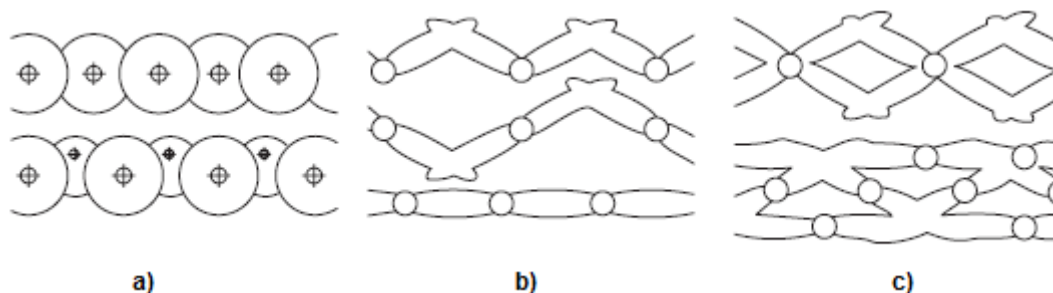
Esquema de estruturas em jet grout: a) cortina de colunas, b) painel simples; c) painel duplo [75]
